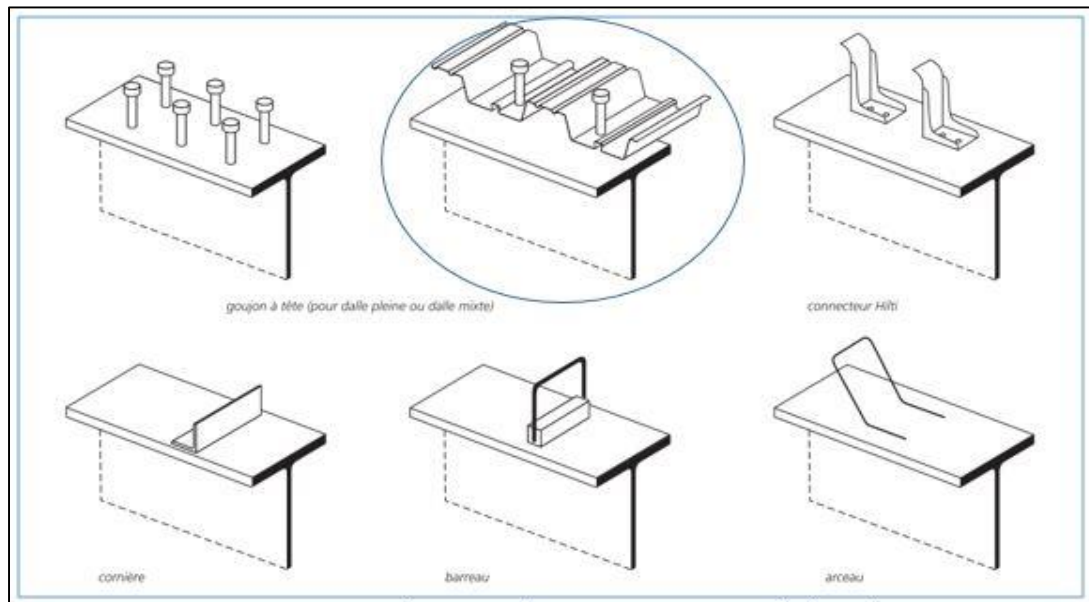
Les types de connexion entre poutre et dalle mixte
